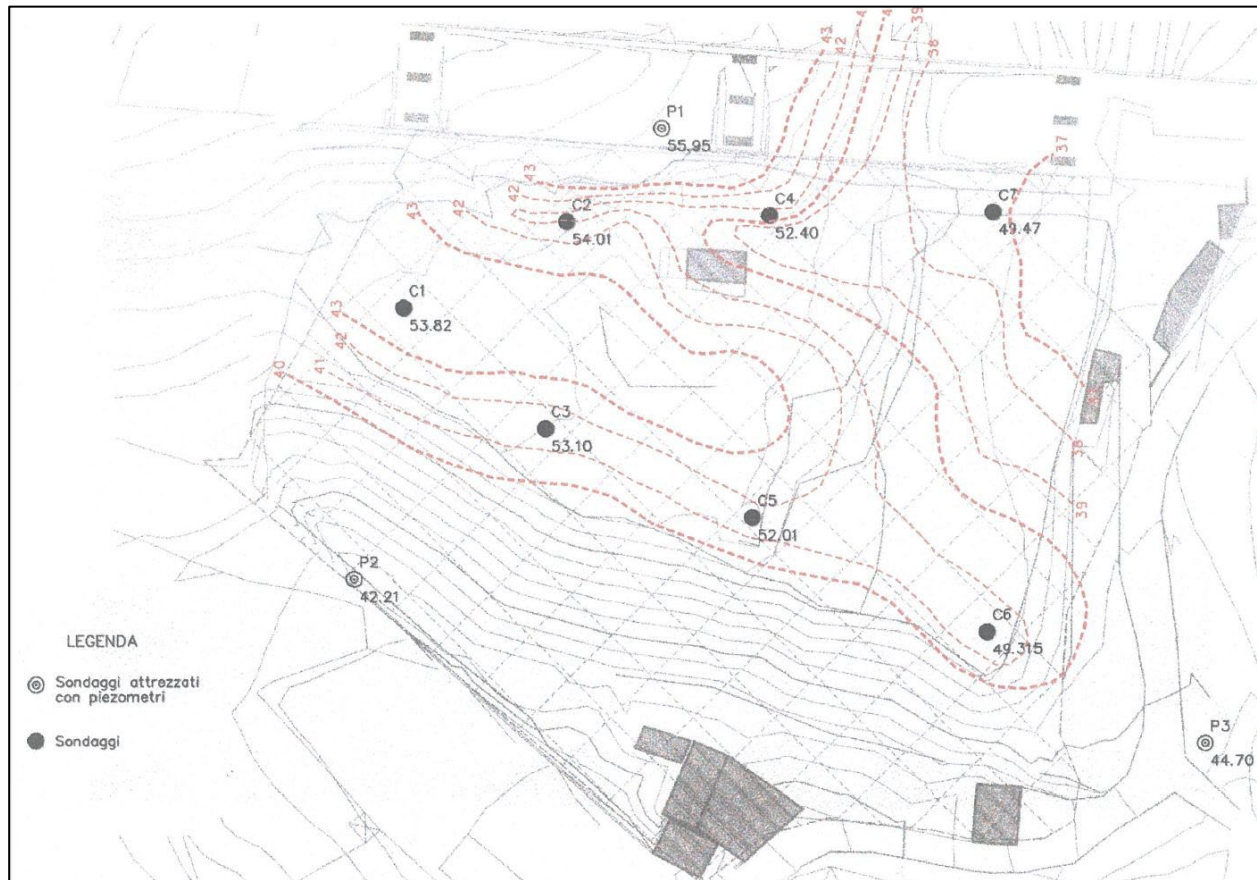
Ubicazione sondaggi e ricostruzione del tetto del substrato (Piano di caratterizzazione Via Piombelli)
